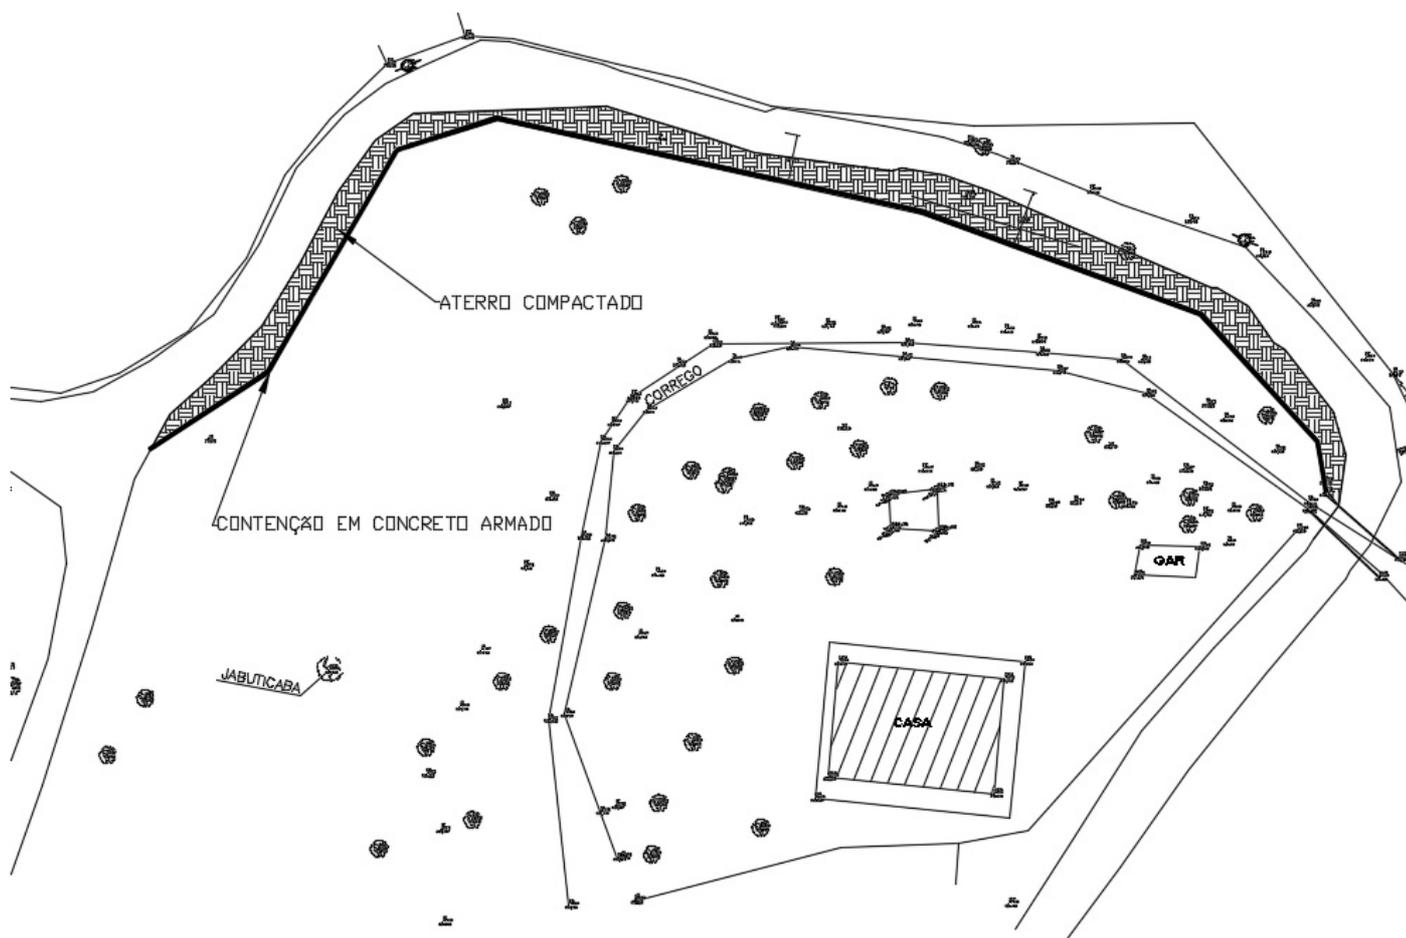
Contenção em Muro de Concreto Armado – Planta
